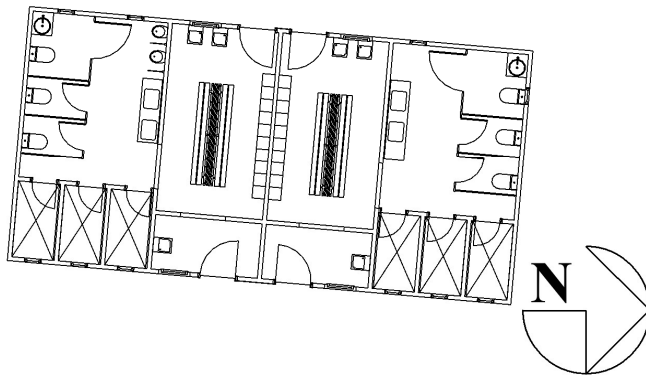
Planta Edificio 2, Zona 2, sin escala.
